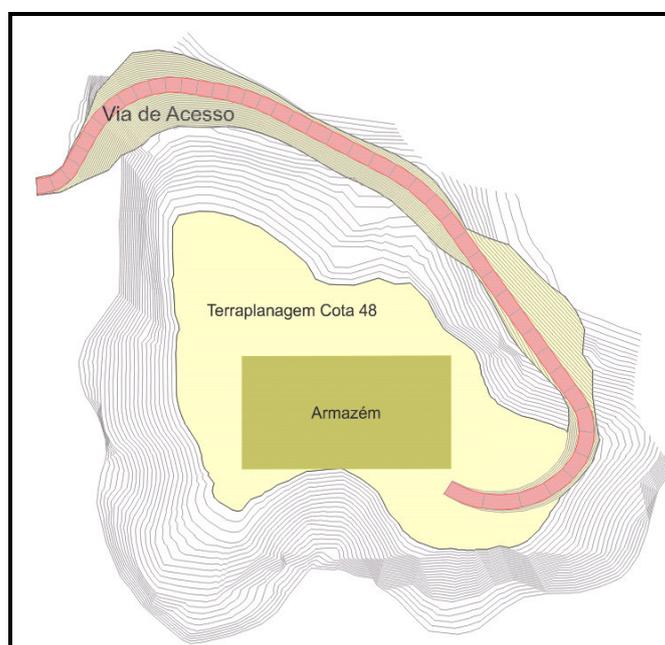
Proposta inicial para instalação da parte terrestre do TGSC
